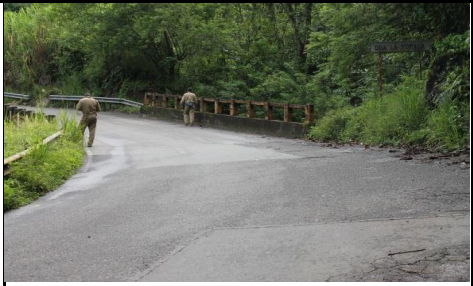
PLACA IDENTIFICACIÓN PUENTE NO EXISTE
